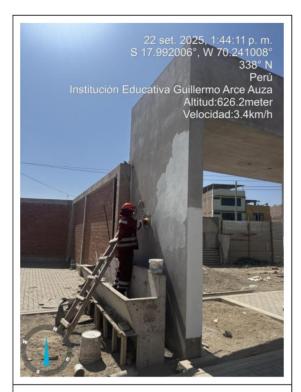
Empastado de muros en pórtico de nivel primario.
